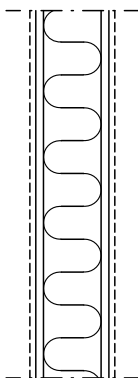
Ytterväggar av plåt-sandwichelement med tjocklek 175 mm
